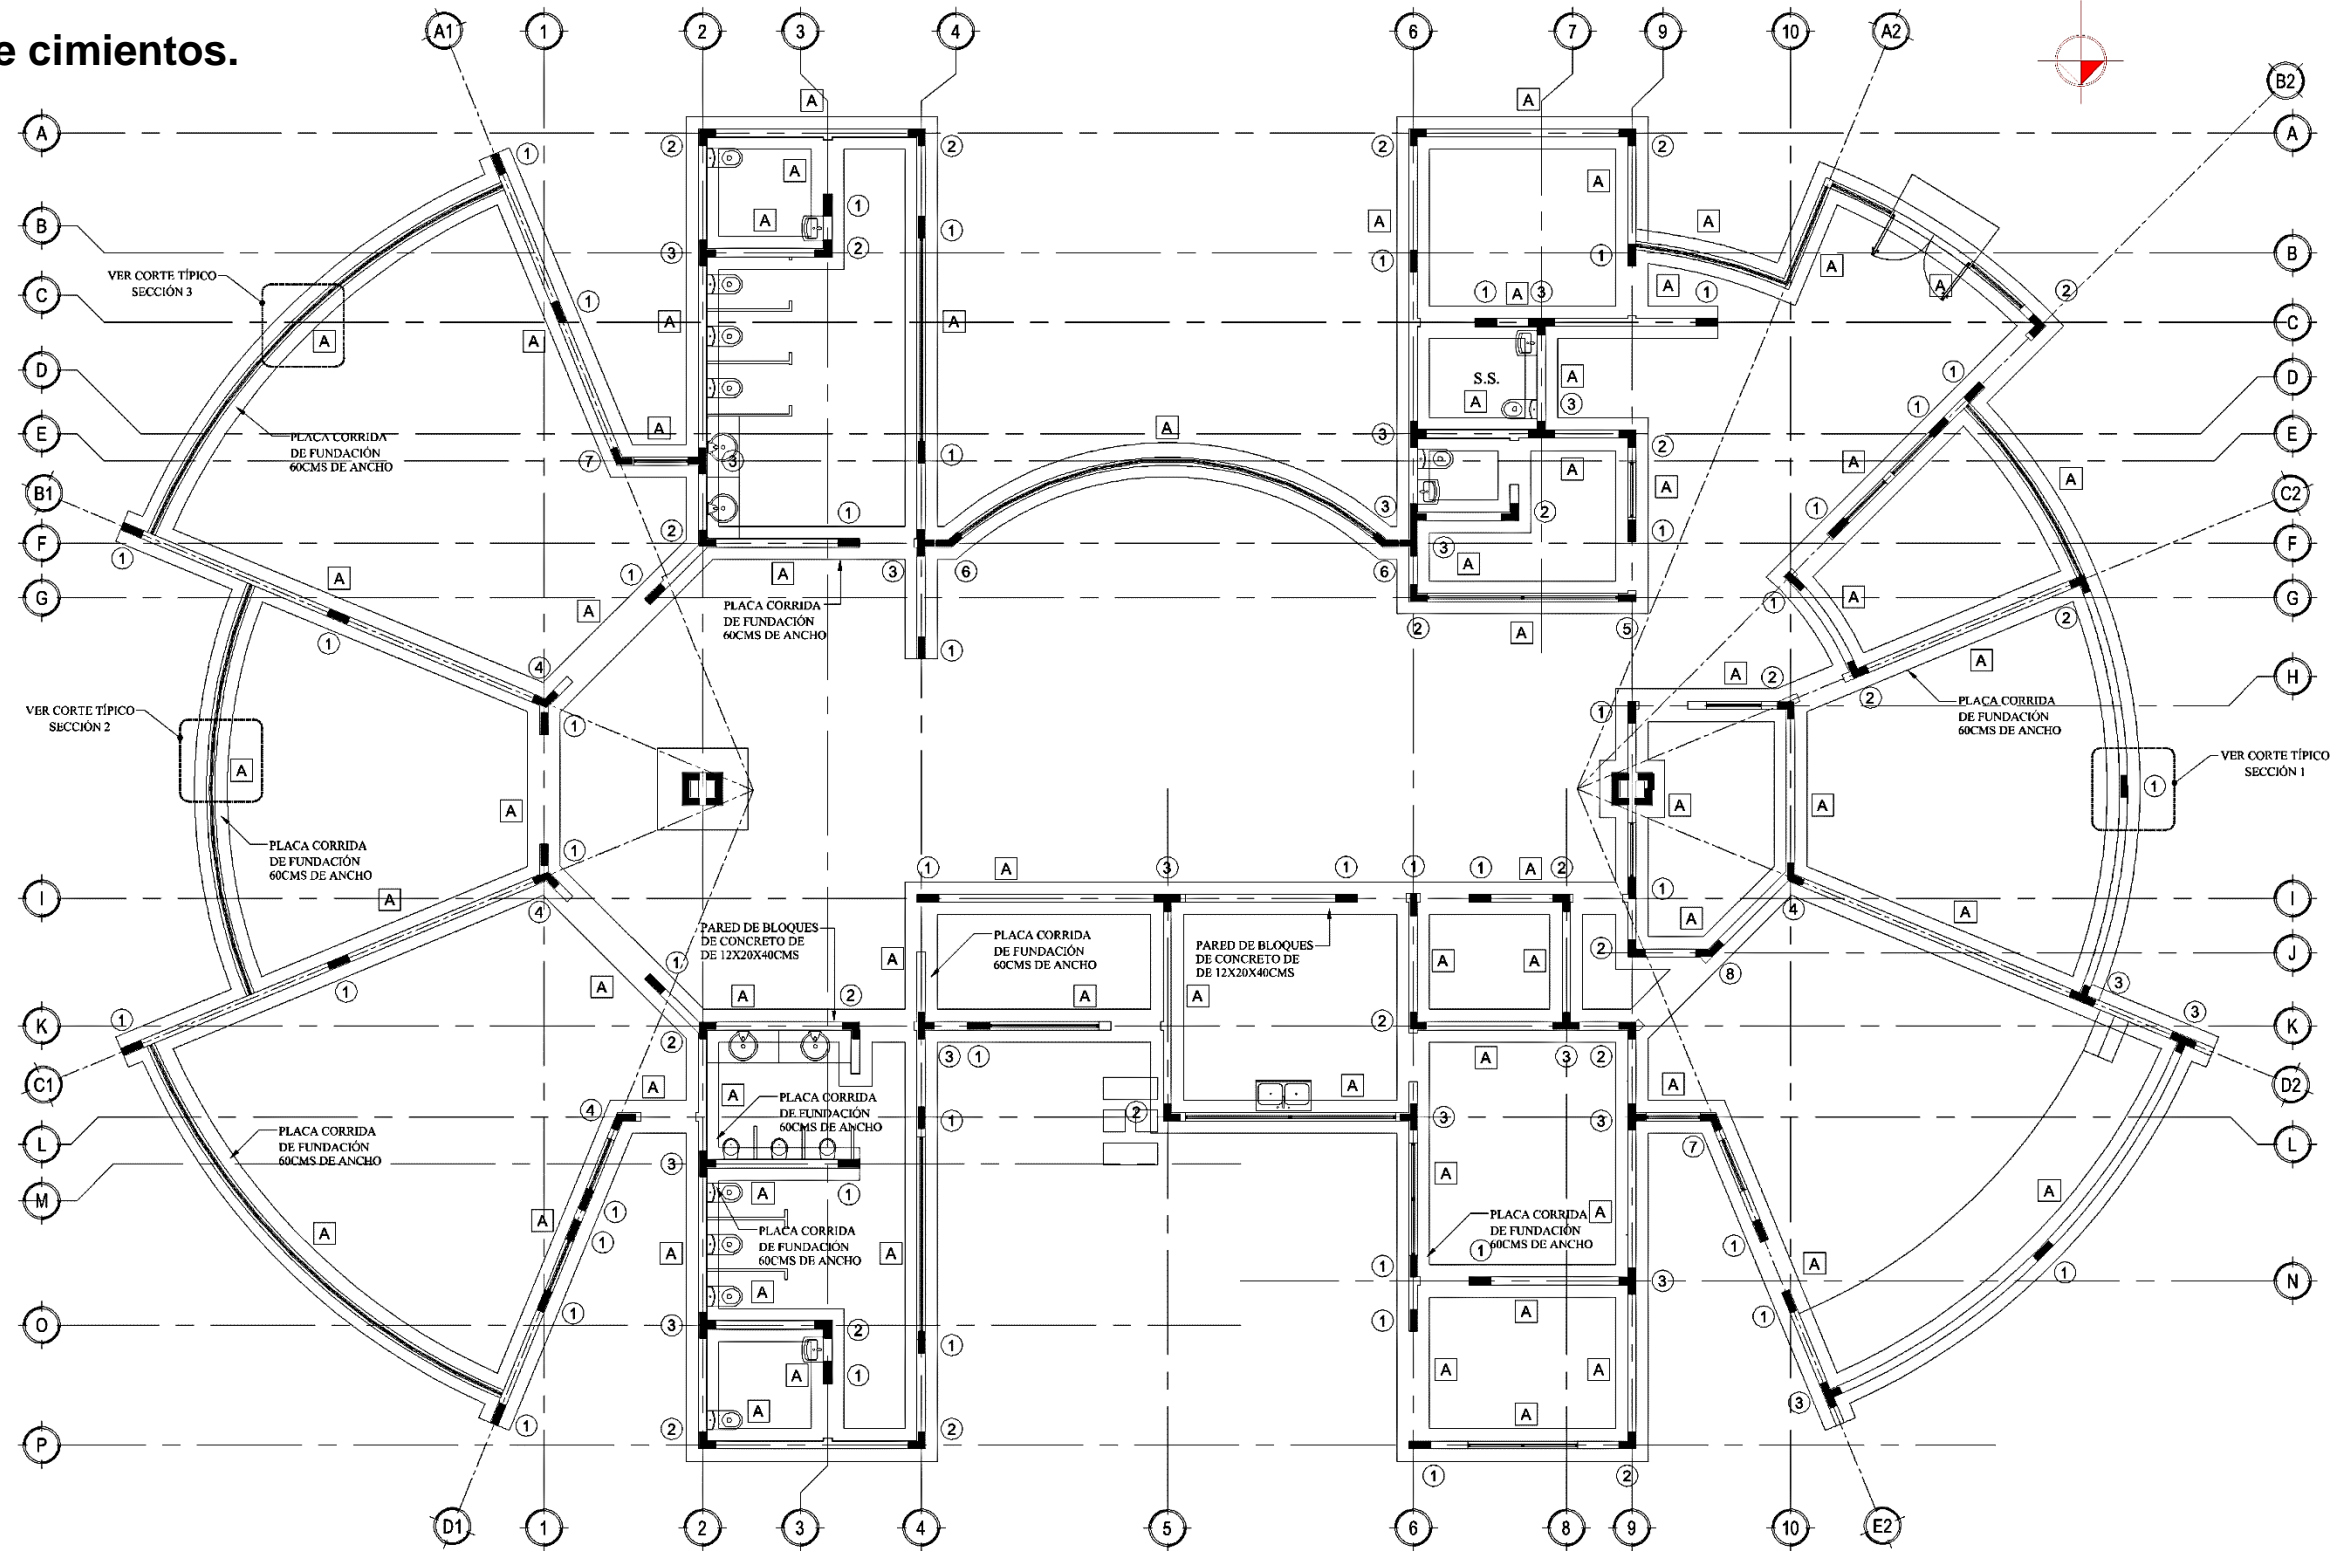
Planta de cimientos. Fuente: elaboración propia.
